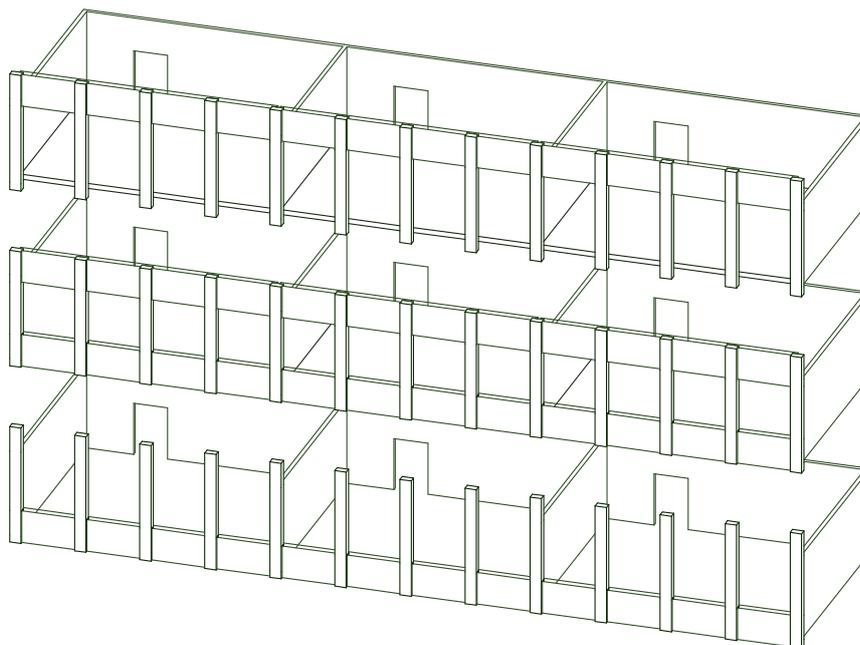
Grundsätzliche Brüstungs- und Sturzsituationen bei Skelettfassaden (oben: FT S1, mittig: FT S2, unten: FT S3)
